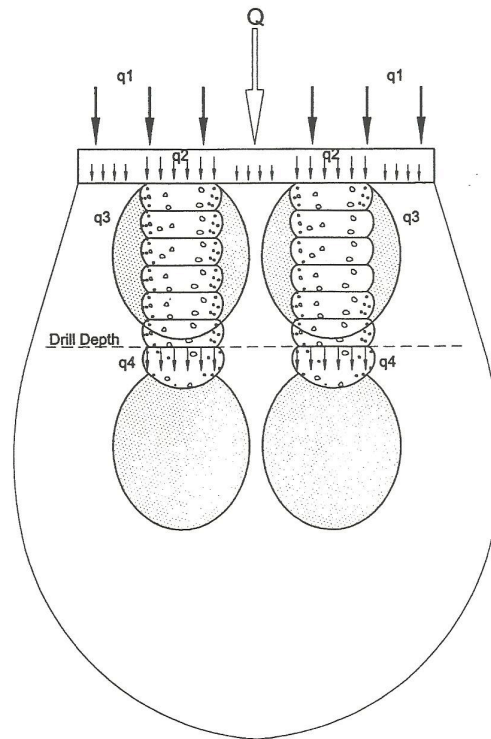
, Prueba de módulo de carga de las pilas de grava compactada.
